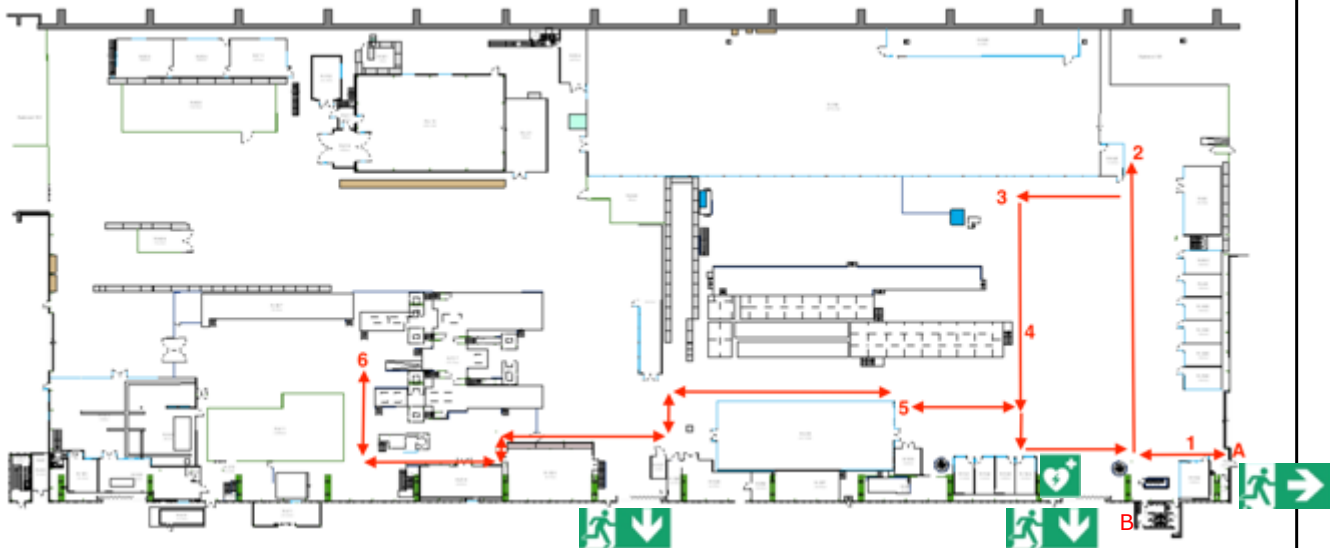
Disposition générale de la zone du bâtiment 180-FAIR
